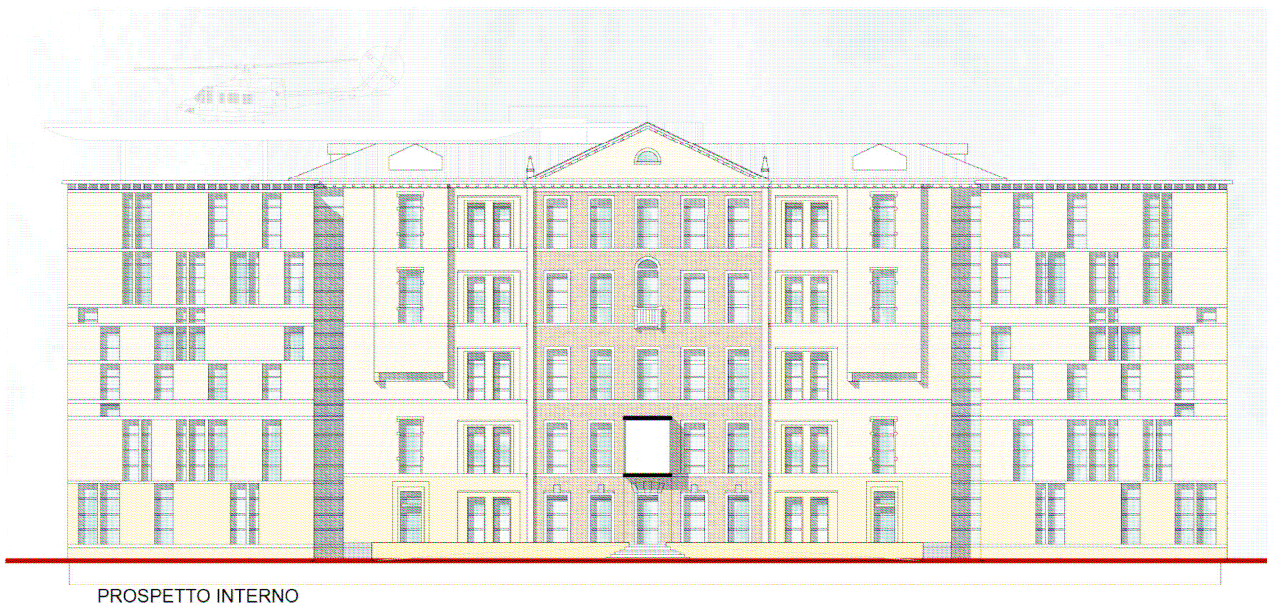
Prospetto nuovo padiglione Jona lato interno all'ospedale
